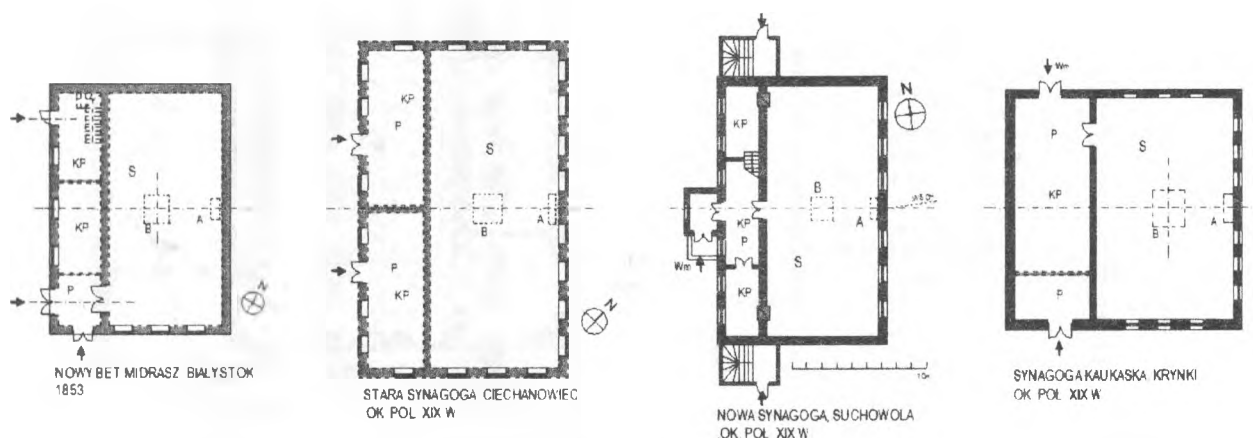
Nowy Bet Midrasz w Białymstoku, z 1853 r., Rysunek 8 – Stara Synagoga w Ciechanowcu fot. zbiory T. Wiśniewskiego stan przed wojną, fot. Księga Pamięci
